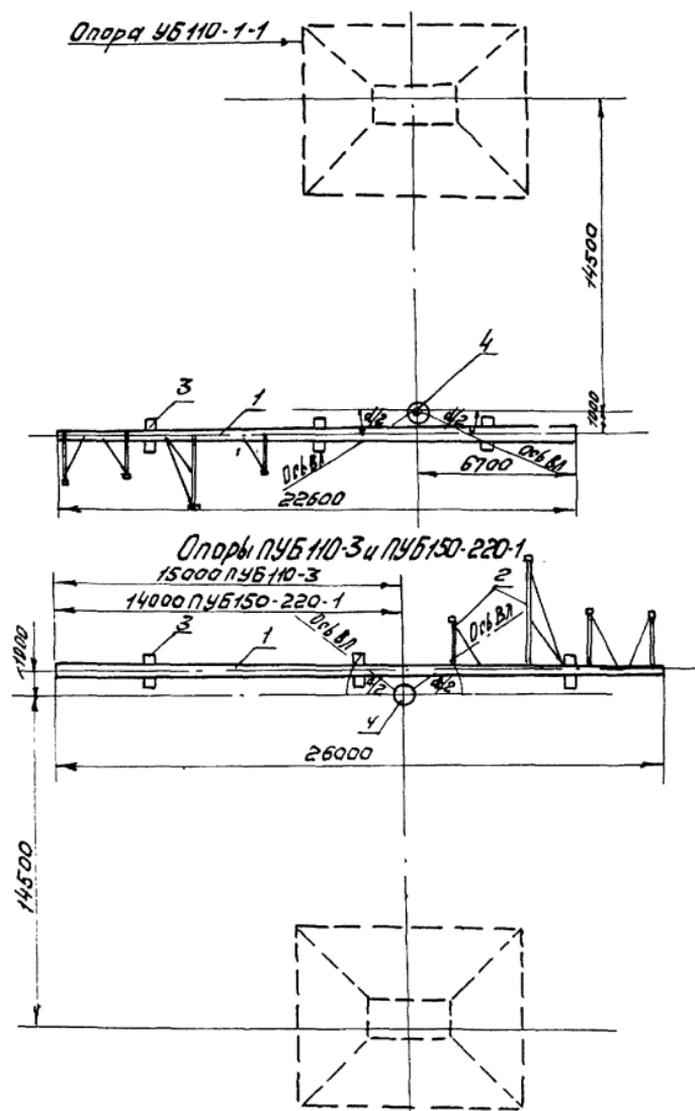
Схема выкладки и сборки опор: ПУБ 110-1-1; ПУБ 110-3; ПУБ 150-220-1
